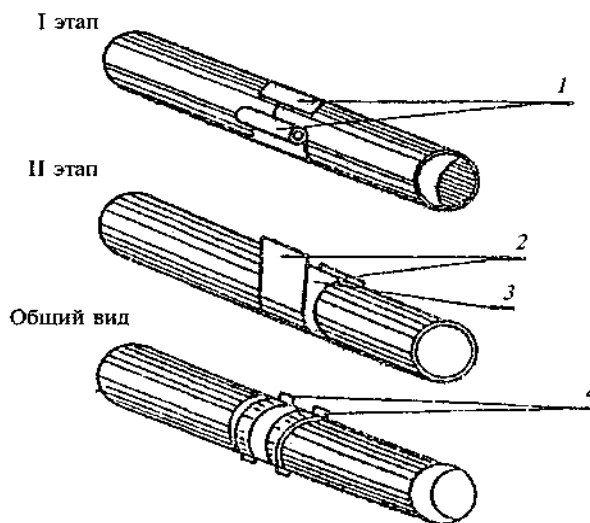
Схема заделки поперечных трещин брезентом или толью в 6—8 слоев с покрытием поверху кровельным железом с постановкой хомутов
